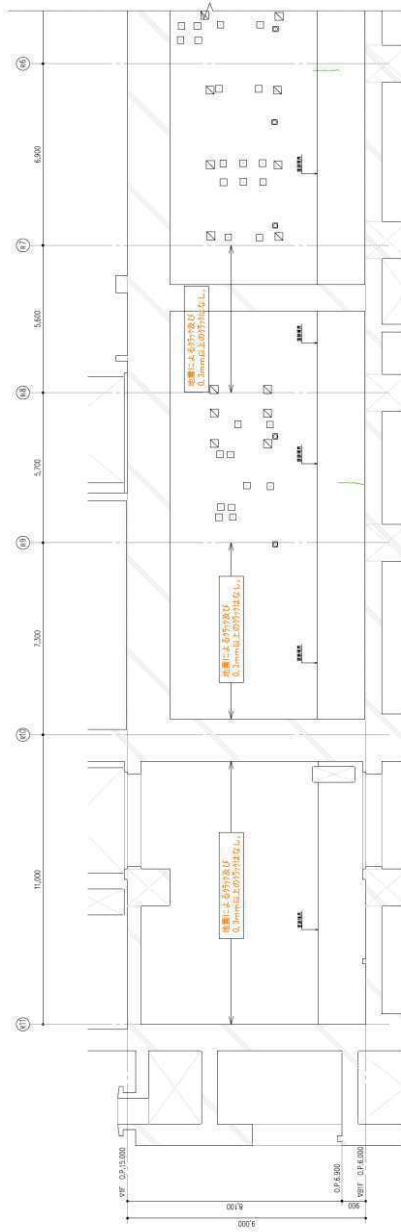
原子炉建屋のひび割れ分布 耐震壁 (25) 地下 1 階 RC 通り
